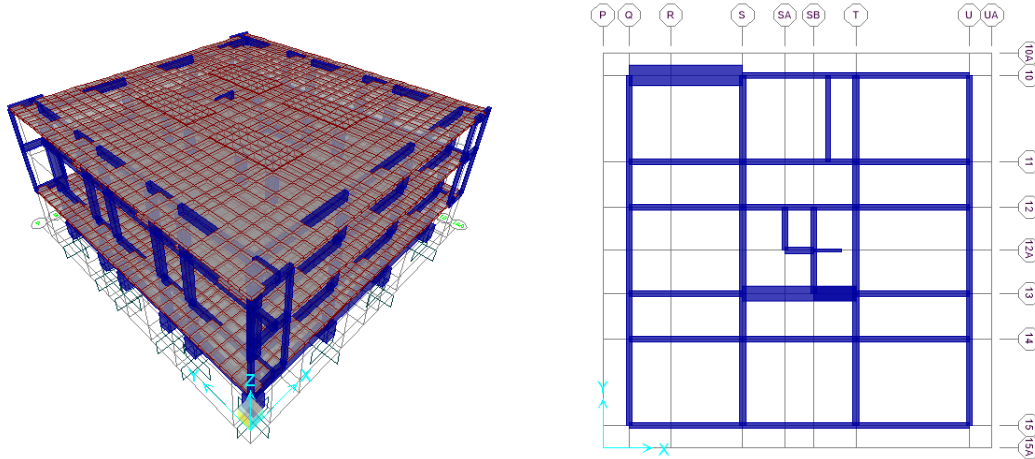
Modelo estrutural (A), planta do primeiro piso (B)
